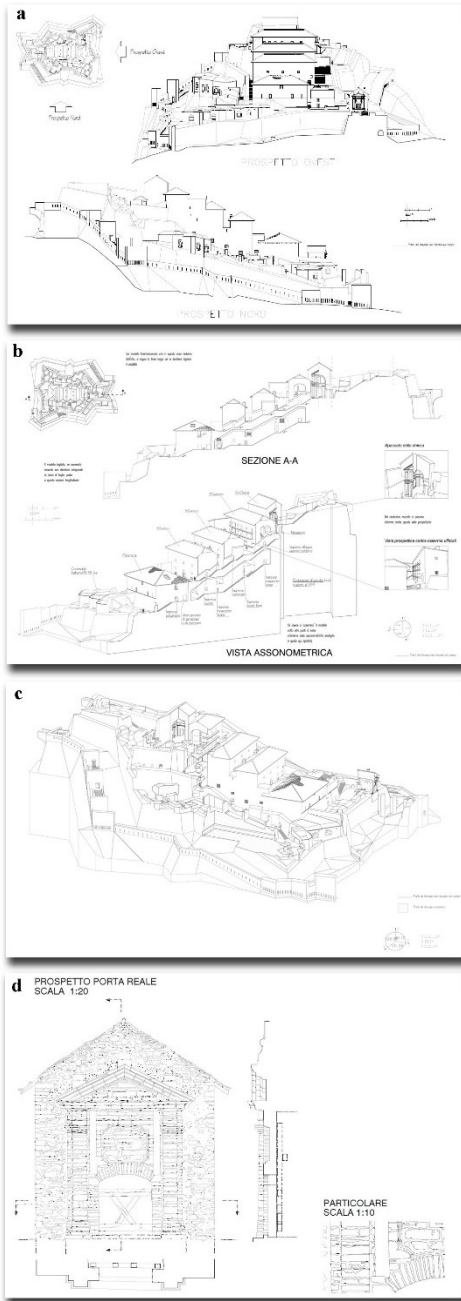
Forte Valli, Ridotta Belvedere. Alcune tavole della tesi di laurea sviluppata nel 1995: a. prospetto Ovest e prospetto Nord; b. sezione longitudinale e vista assonometrica; c. spaccato assonometrico; d. dettaglio della Porta Reale. Fonte: Bassi Gerbi et al, 1995).
